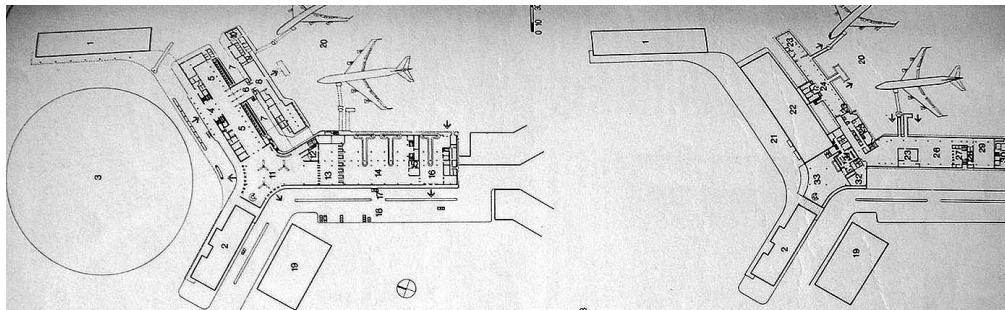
Planta Baja y Planta Alta de la remodelación del edificio Aeroestación Fuente: Revista Construcciones n° 268
